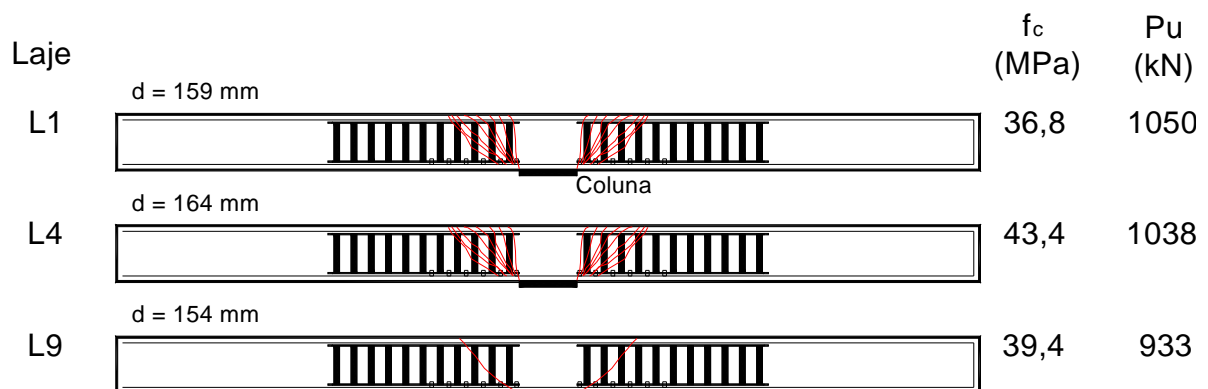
Desenho esquemático das lajes ensaiadas em corte com as cargas e as prováveis superfícies de ruptura.
